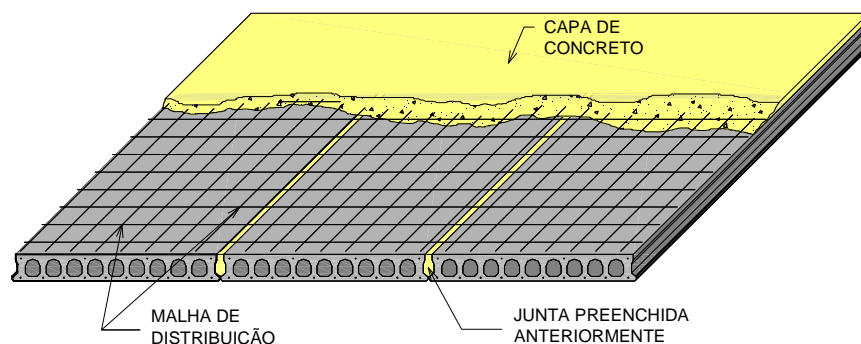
Capa de concreto executada sobre as lajes alveolares
